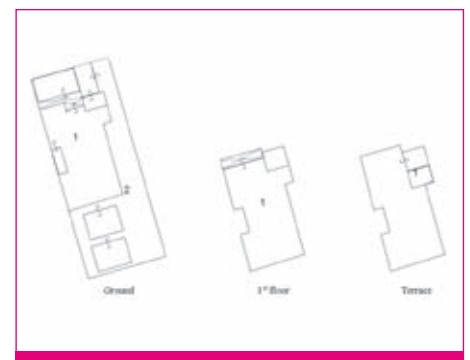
'Floor plan' met twee kadastrale objecten verdeeld over begane grond en eerste en tweede verdieping (voorbeeld uit Cyprus).
